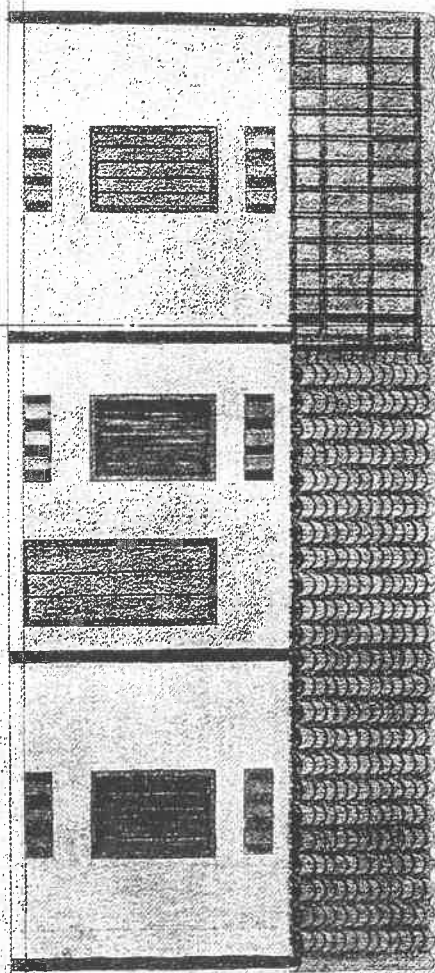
ALZADOS Y CORTE DE LA VIVIENDA.
